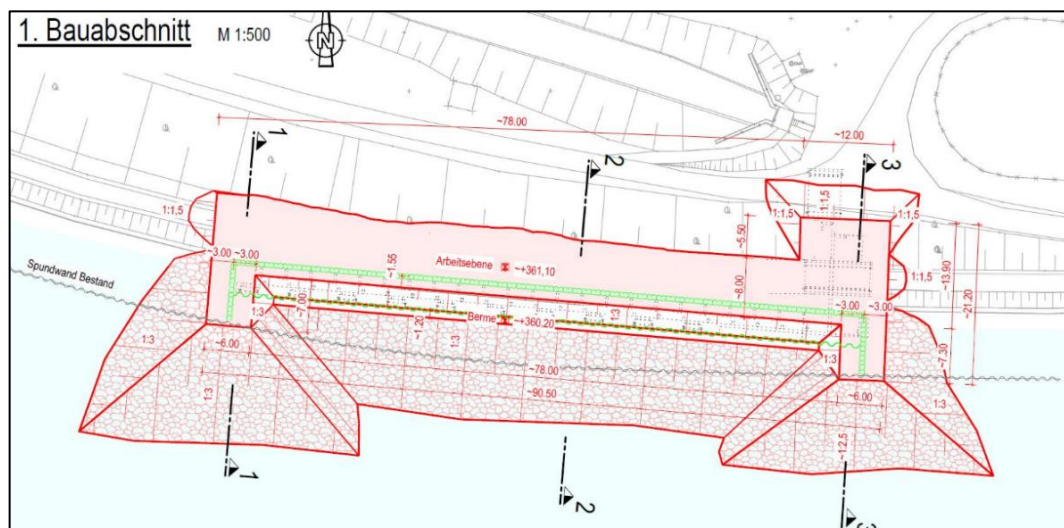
Draufsicht Baugrube Einstiegsbauwerk mit Aussteifung
